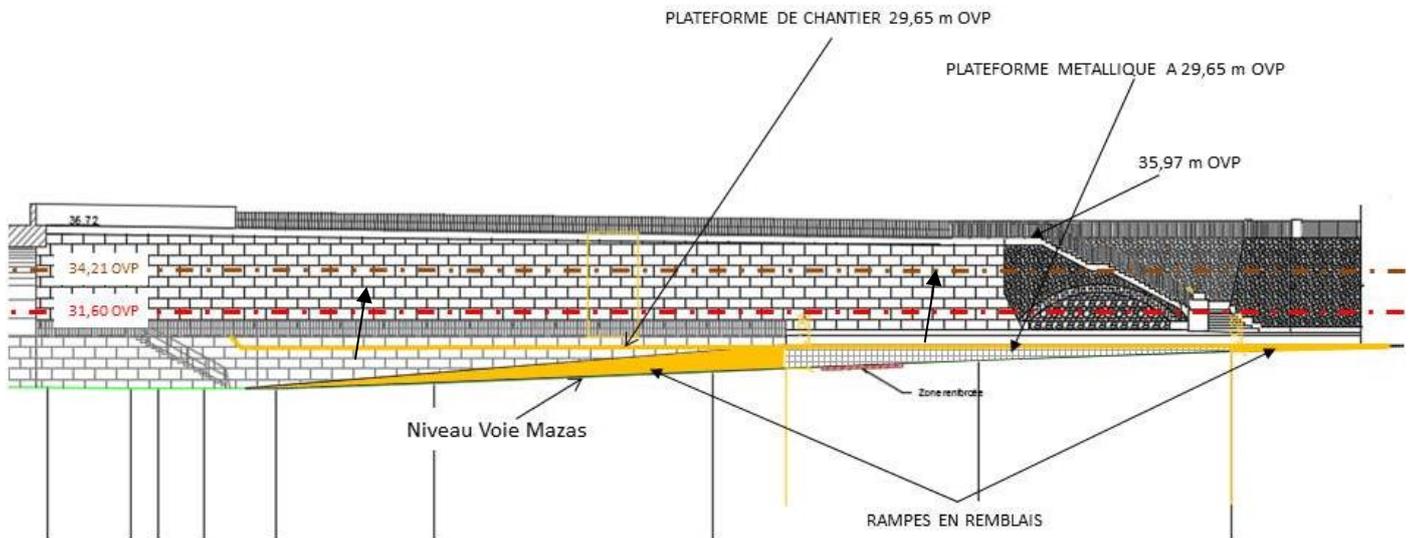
Coupe des rampes et plateforme réalisées au niveau de la zone de travaux
